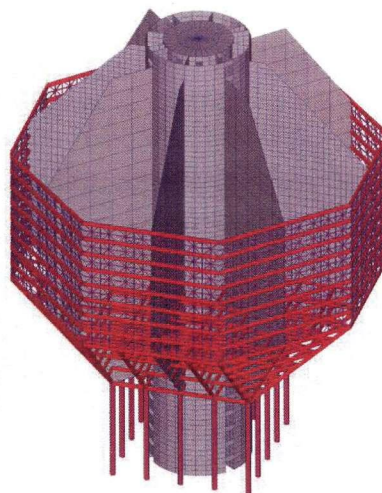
Вариант 4 конструктивной схемы здания книгохранилища (несущими элементами, воспринимающими нагрузку от элементов каркаса, являются круглый железобетонный ствол с 8-ю диафрагмами, раскосная решетка по периметру и трубобетонные колонны)
